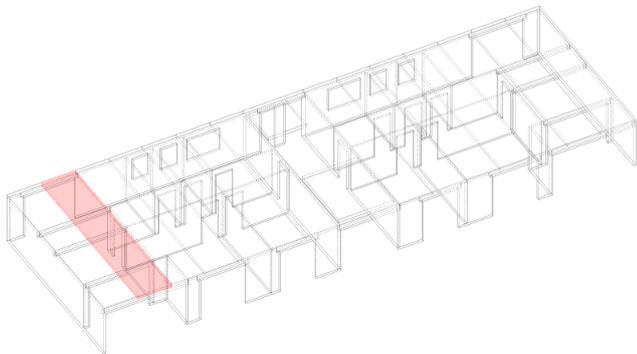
Brettsperrholz-Deckensystem über dem Erdgeschoss
